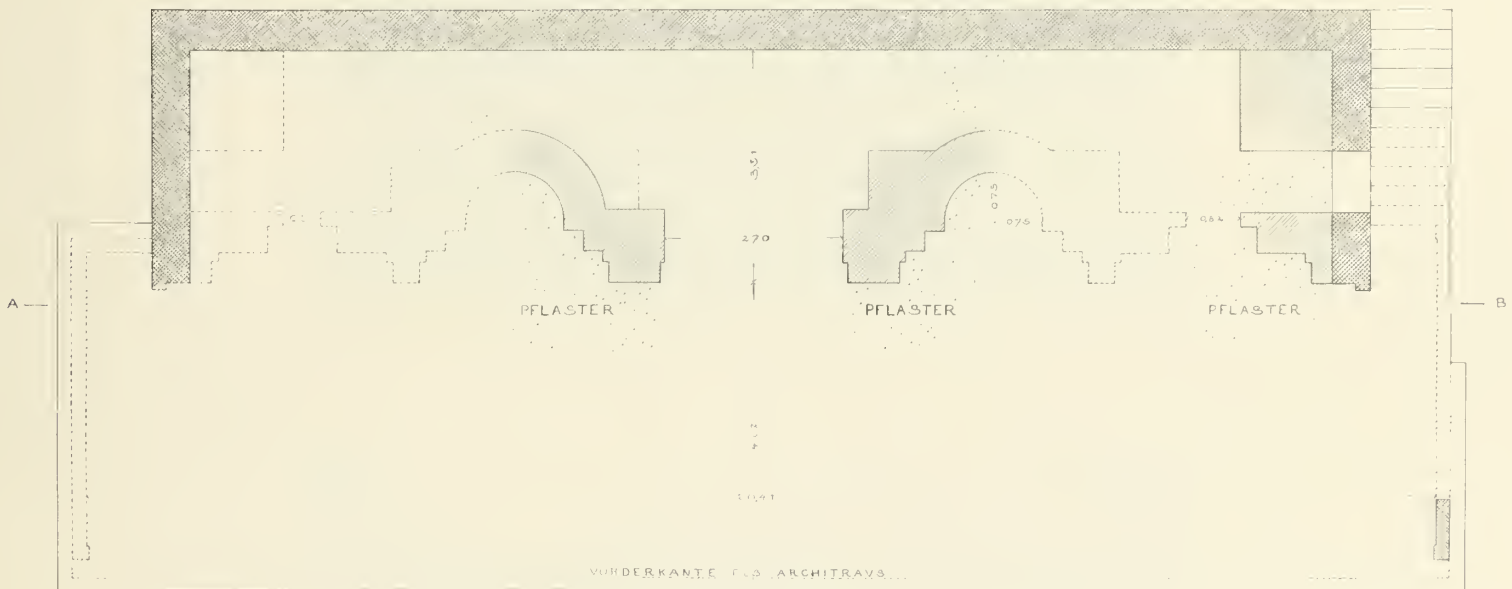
Grundriss des römischen Obergeschosses. Rekonstruktion.
